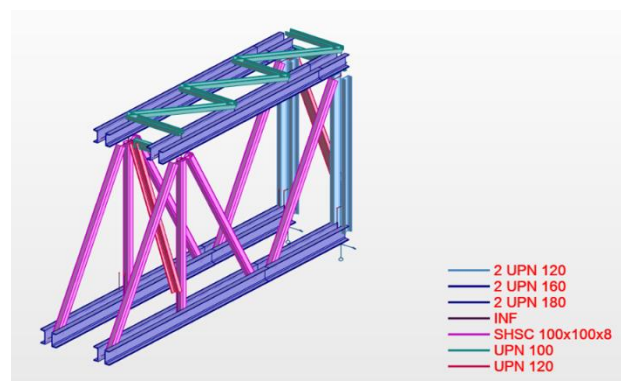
Módulos finais de uma viga longitudinal da ponte de 27 m, destacando as diferentes secções transversais utilizadas.
